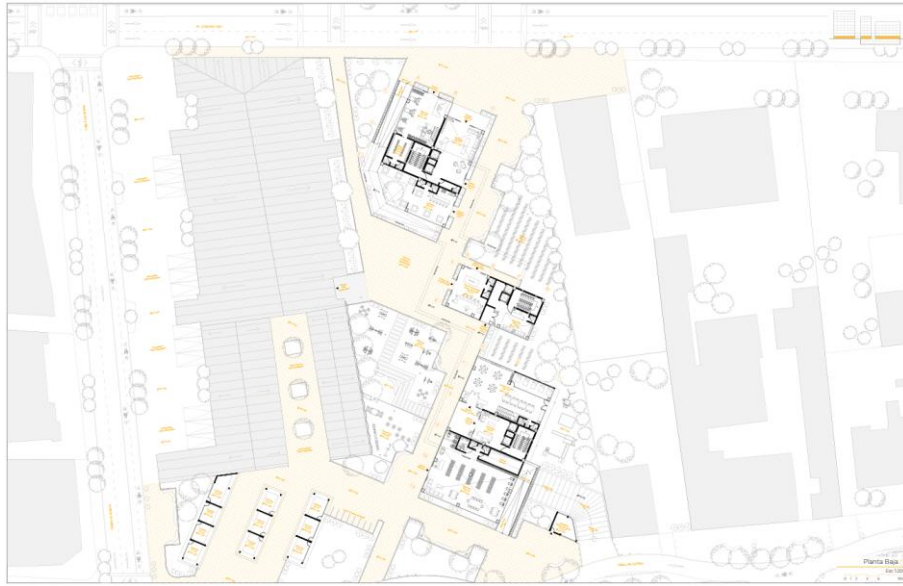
Planta Baja Fuente: Memoria Gráfica-Elaboración Propia
